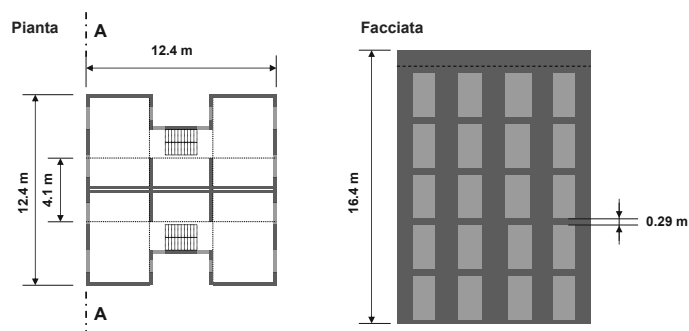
pianta e facciata di un edificio di 6 piani con struttura portante in legno
